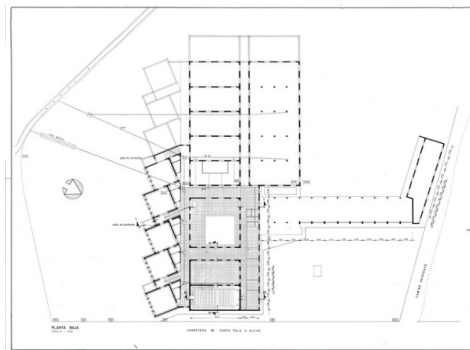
Plano de planta baja del proyecto inicial del Instituto laboral en Elche. Rafael Aburto, 1956. AGUN
